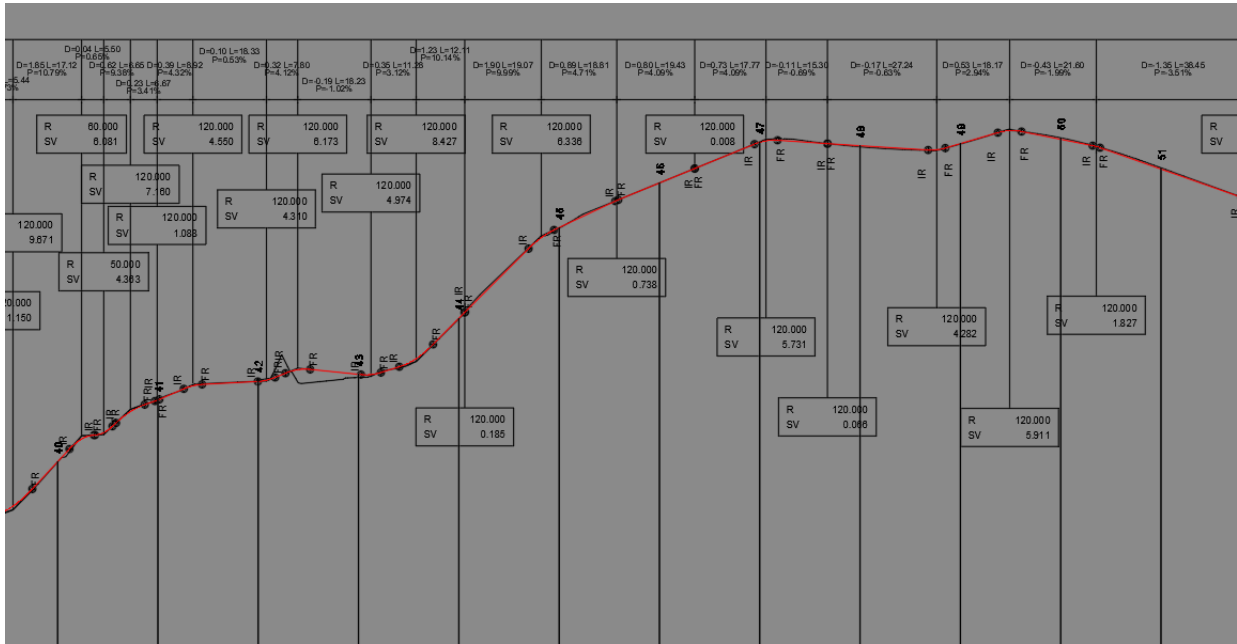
Stralcio Profilo Longitudinale Ramo Nord
